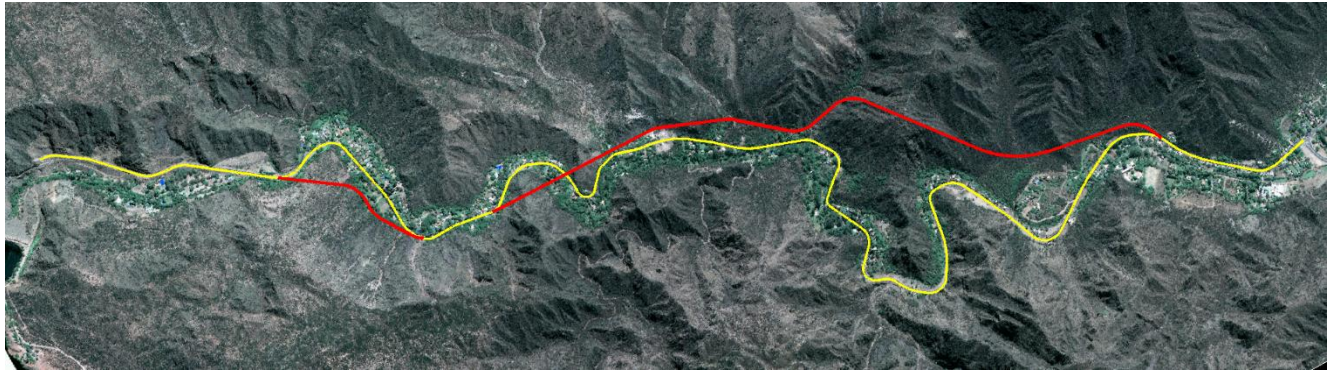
Alternativa 3 (Amarillo: Traza Existente - Rojo: Proyecto)
